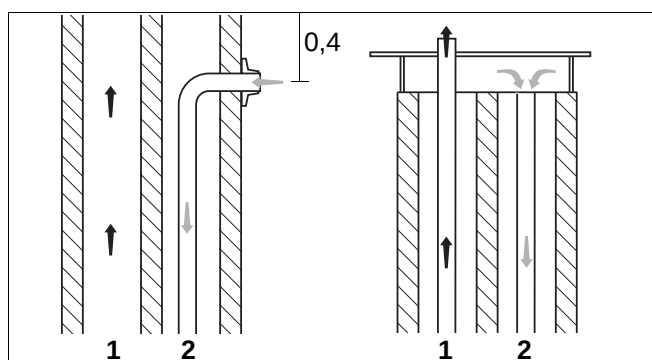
Exemples de construction d'ouvertures (dimensions en m)
